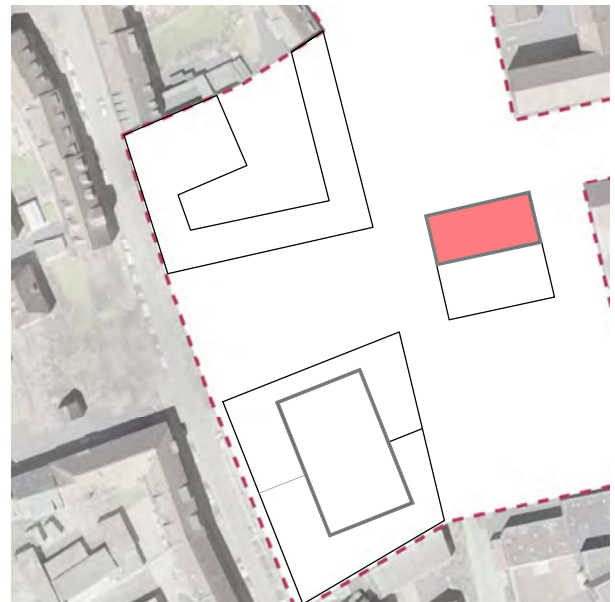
Grundriss OG3 Großer Hof V2
